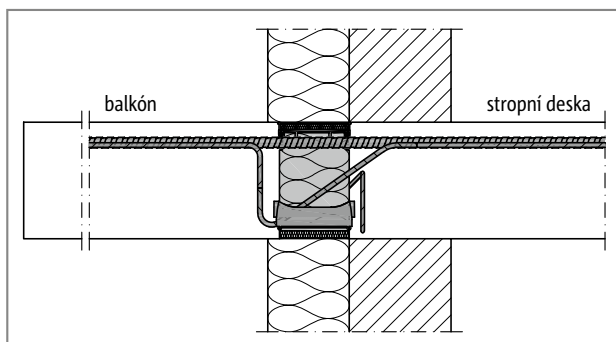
Schöck Isokorb® CXT typ KL: Volně vyložený balkón
